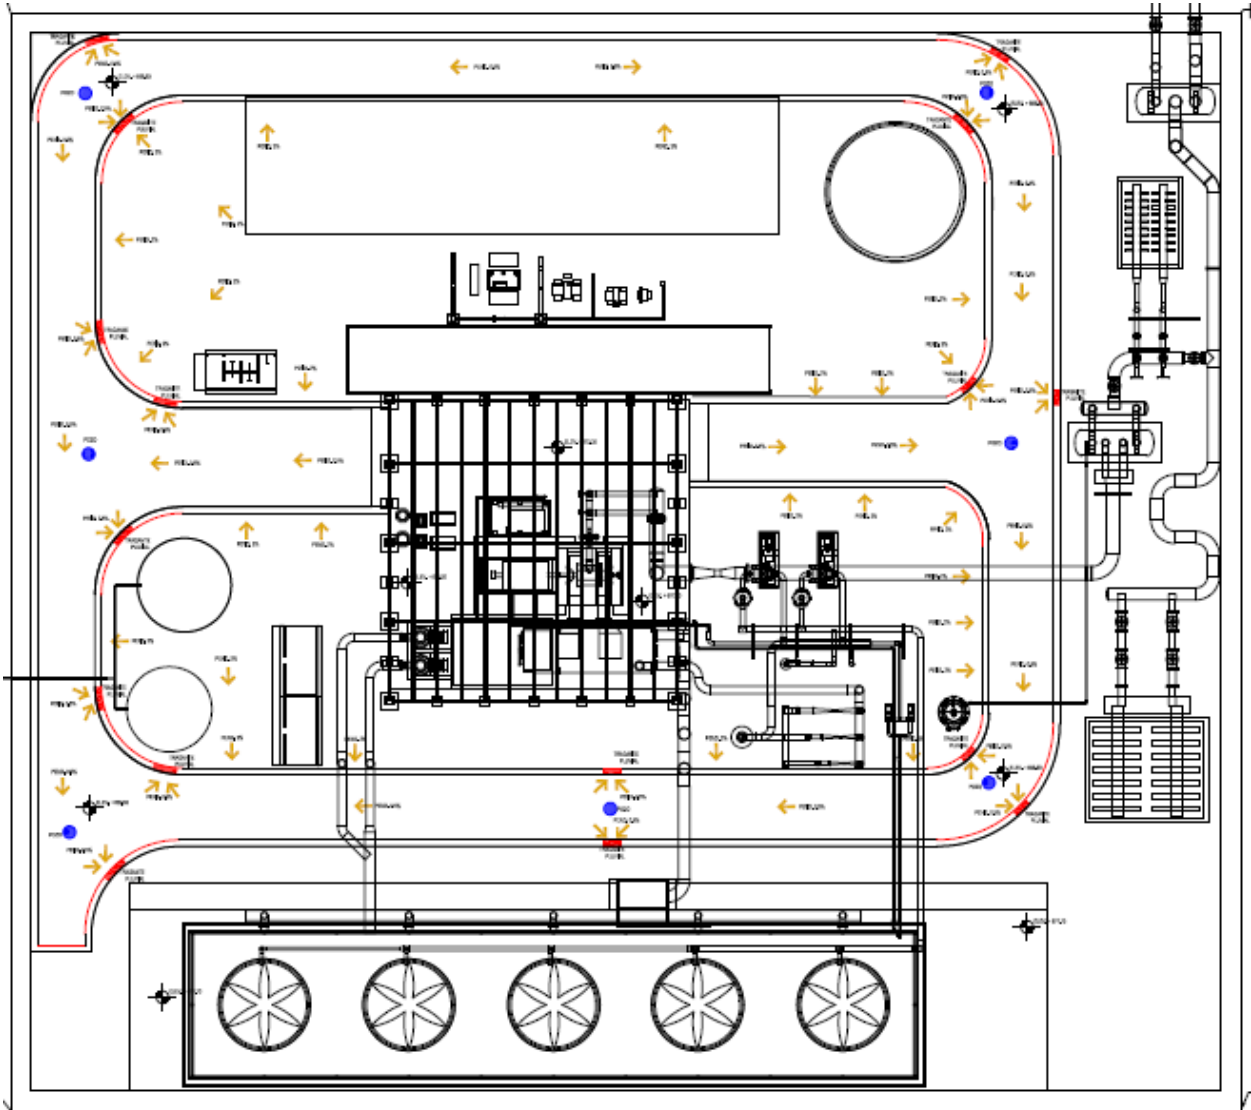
Drenaje pluvial en plataforma de la central geotermoeléctrica
